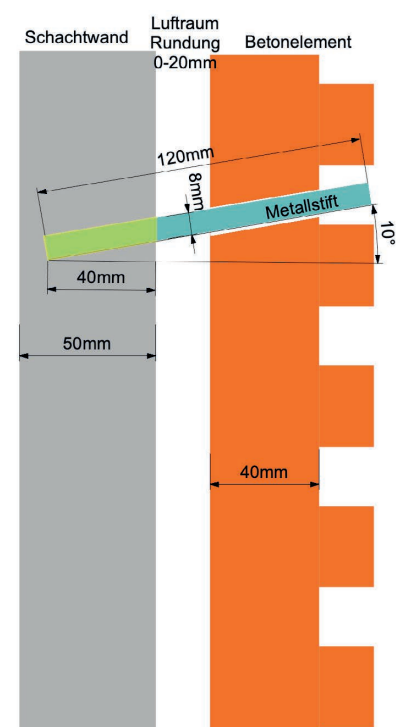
Montage des Amfix® Betonelements mittels Metallstift an Schachtwand.
